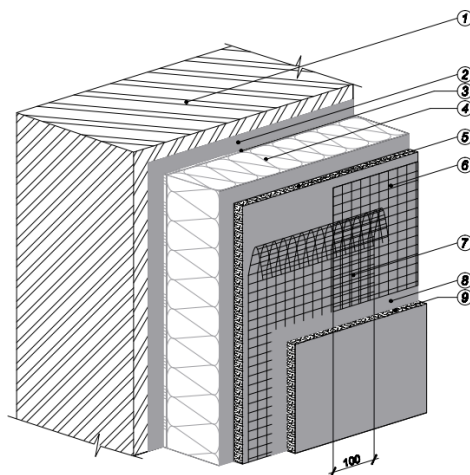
Общая конструкция фасадной системы с наружным штукатурным слоем
